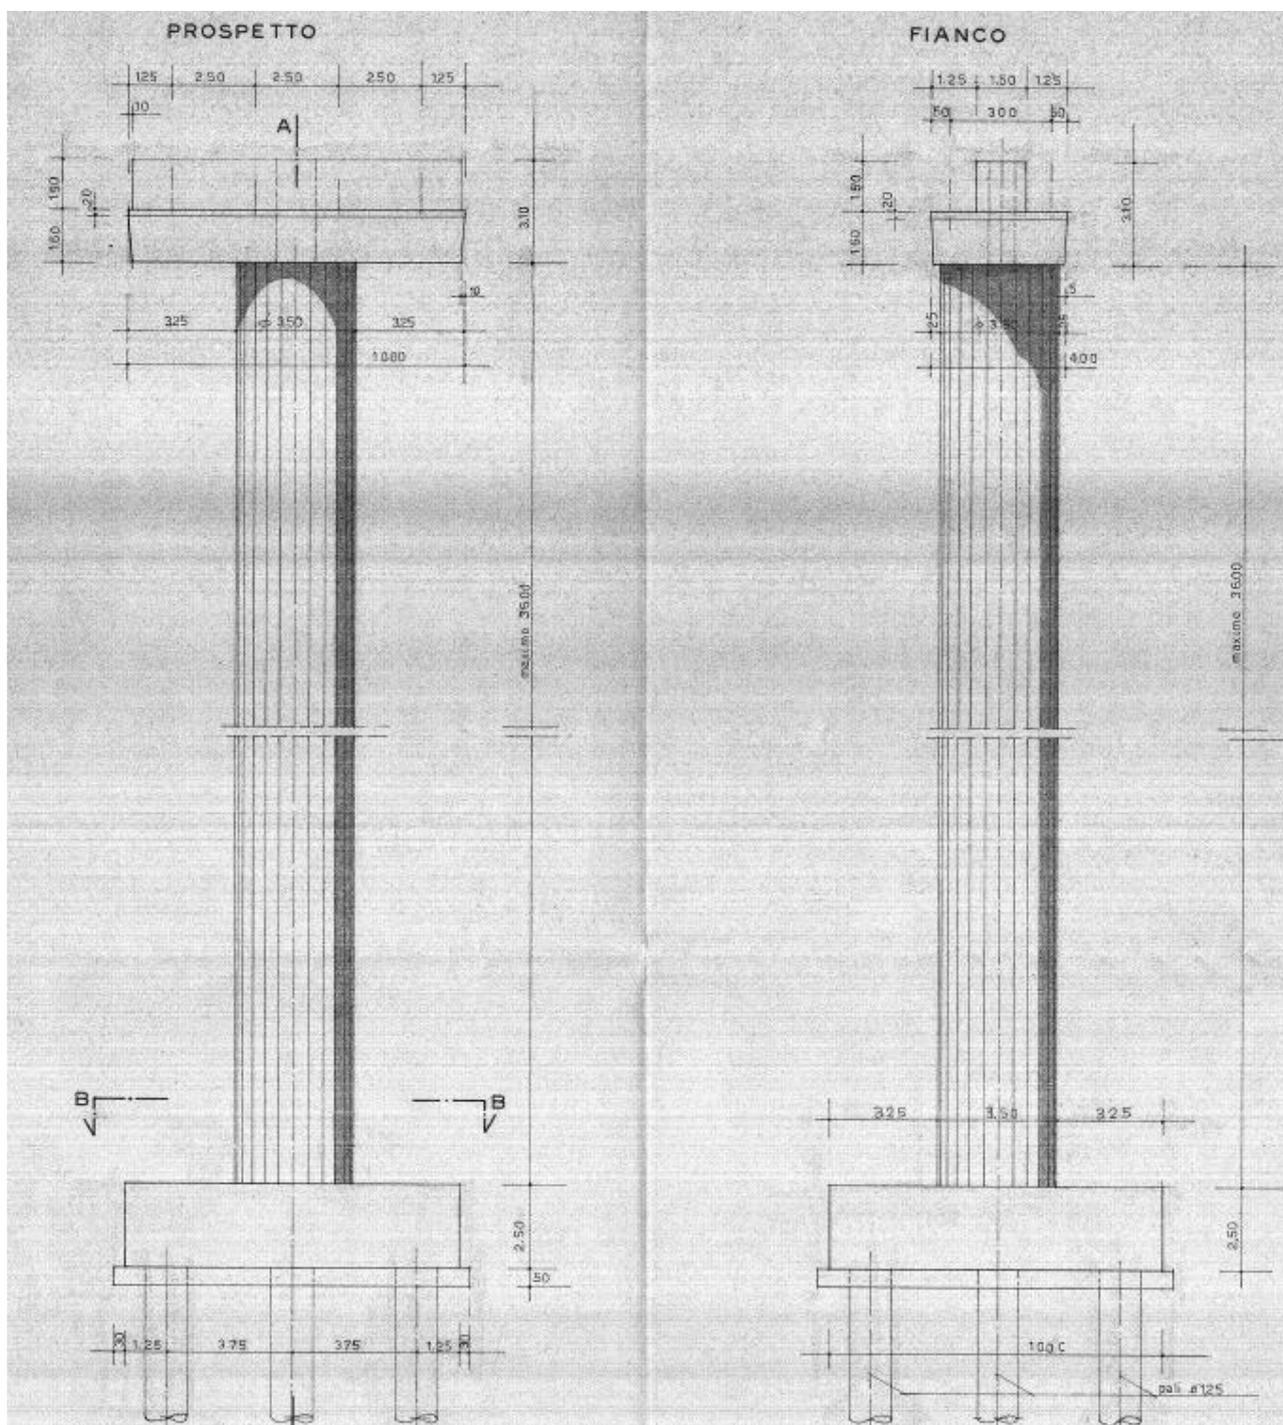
Impalcato a 4 travi in CAP – Prospetti pile e pulvini
